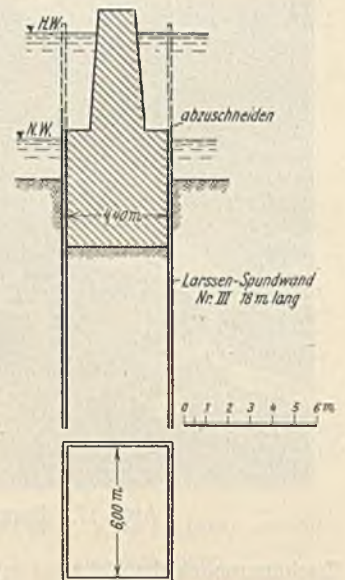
Pfeiler einer eingleisigen Eisenbahnbrücke über den Toyo-Fluß. (Aichi-Bahn, Japan.)
